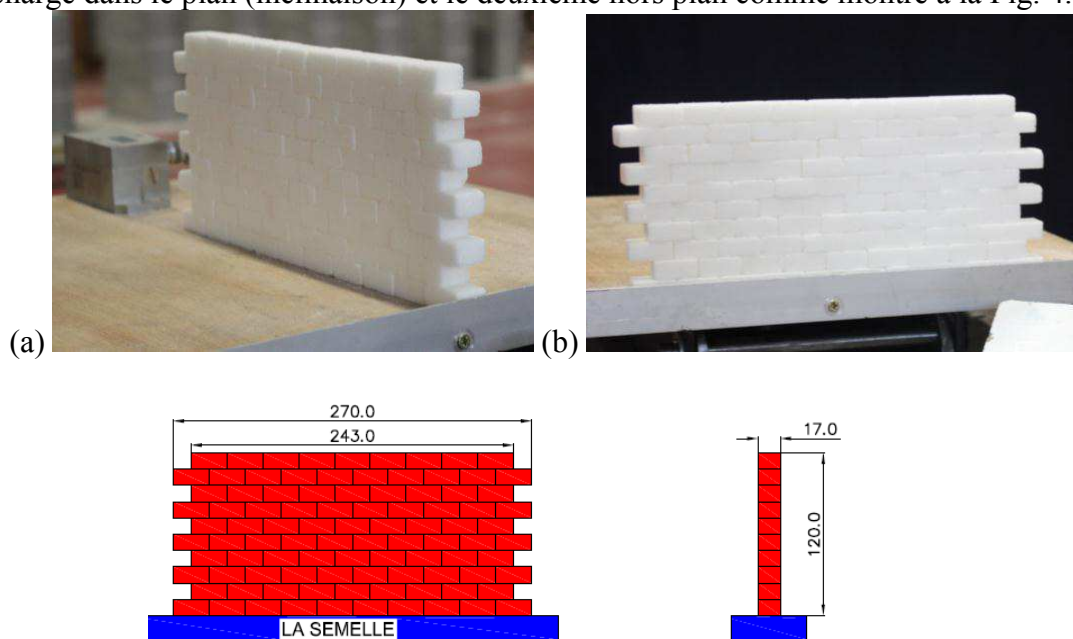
(a) Mode hors plan ; (b) Mode plan
